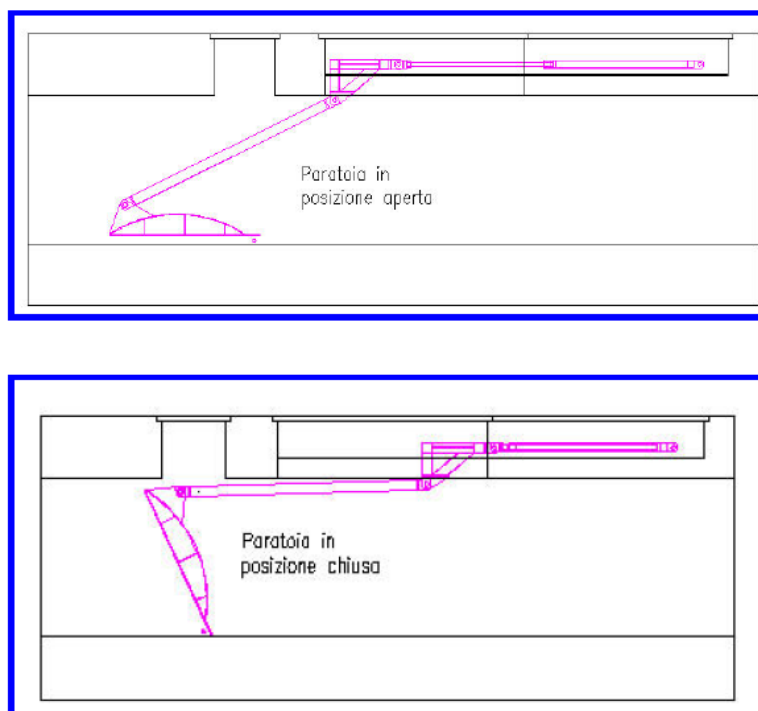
Posizionamenti possibili della paratoia dell'impianto Sortie
